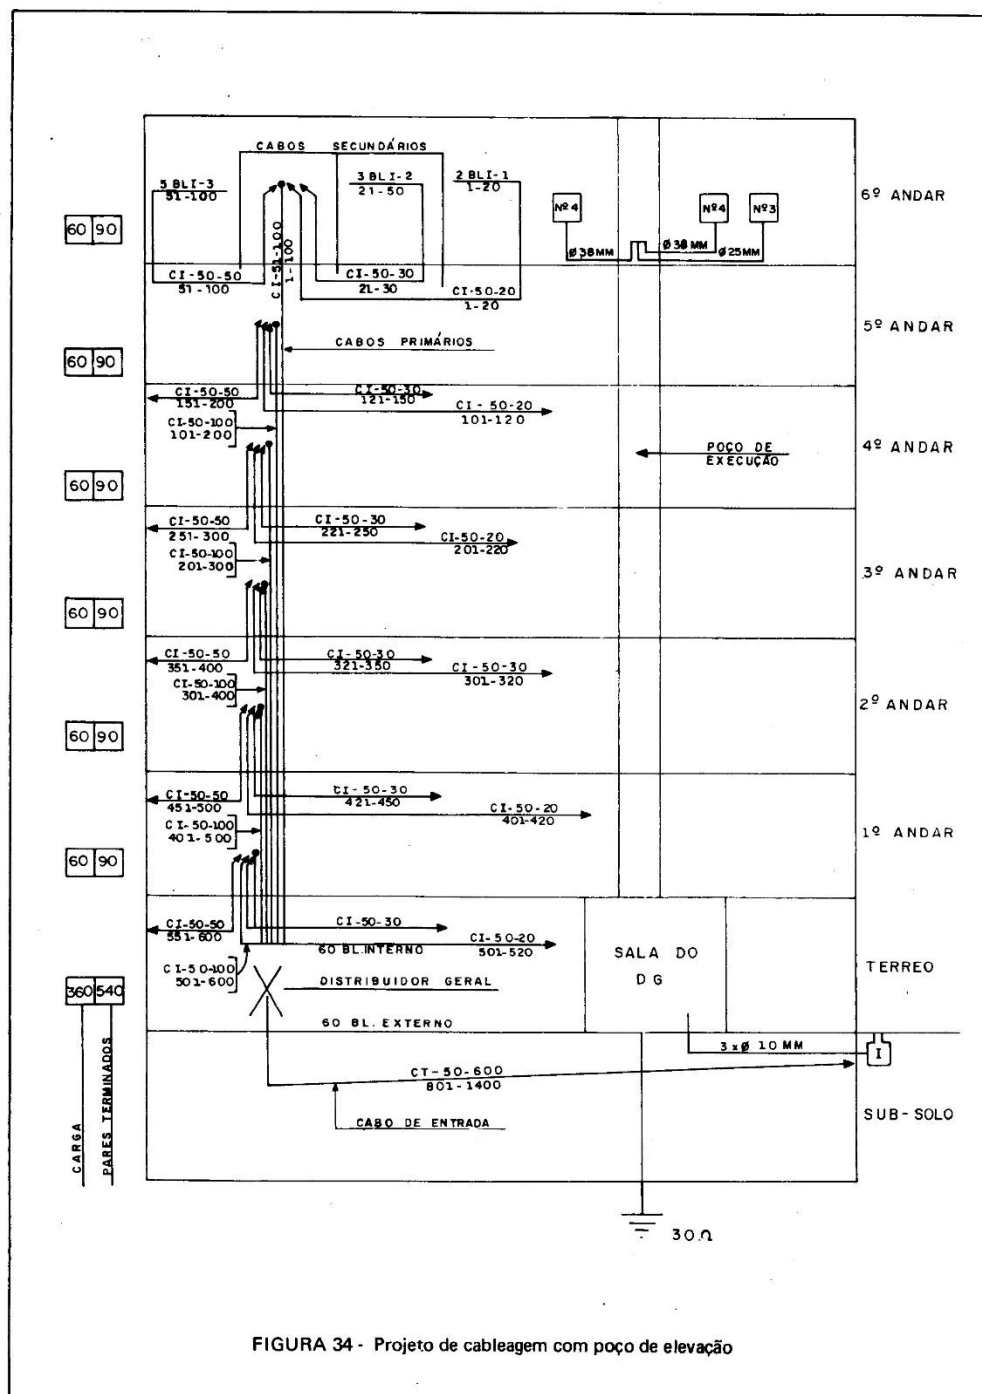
Projeto de cabeleagem com poço de elevação
